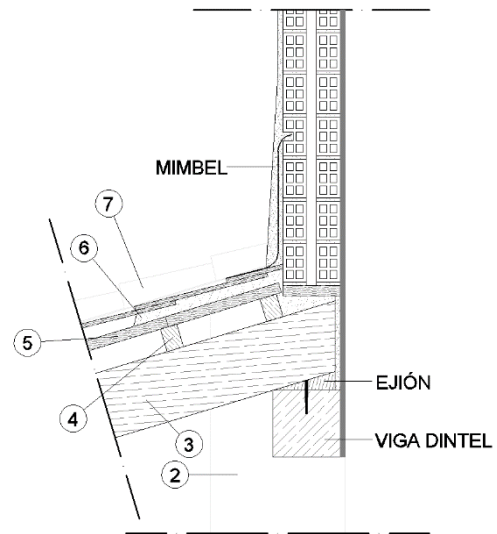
Detalle de cubierta del edificio. Fuente propia.
